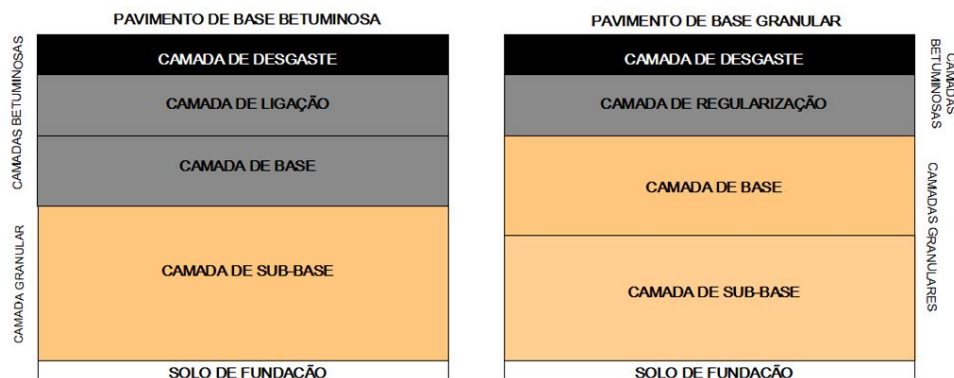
Estruturas tipo de pavimentos flexíveis
